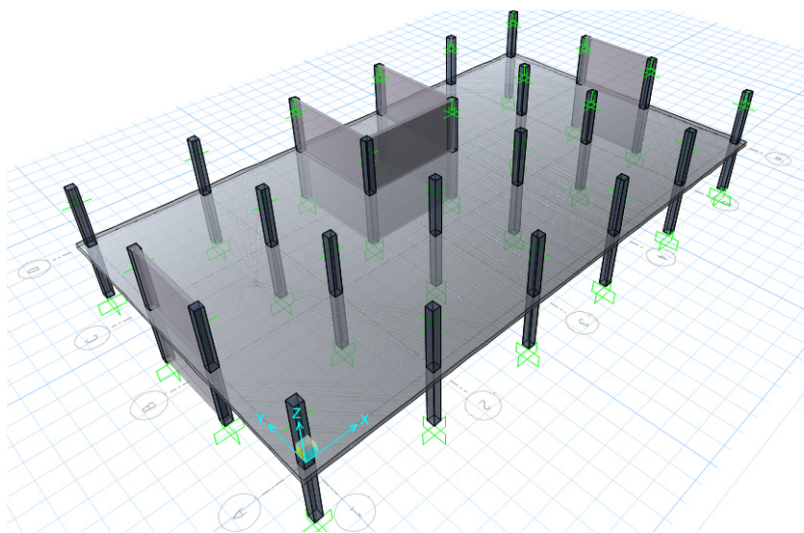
Исходная расчетная схема монолитного перекрытия
